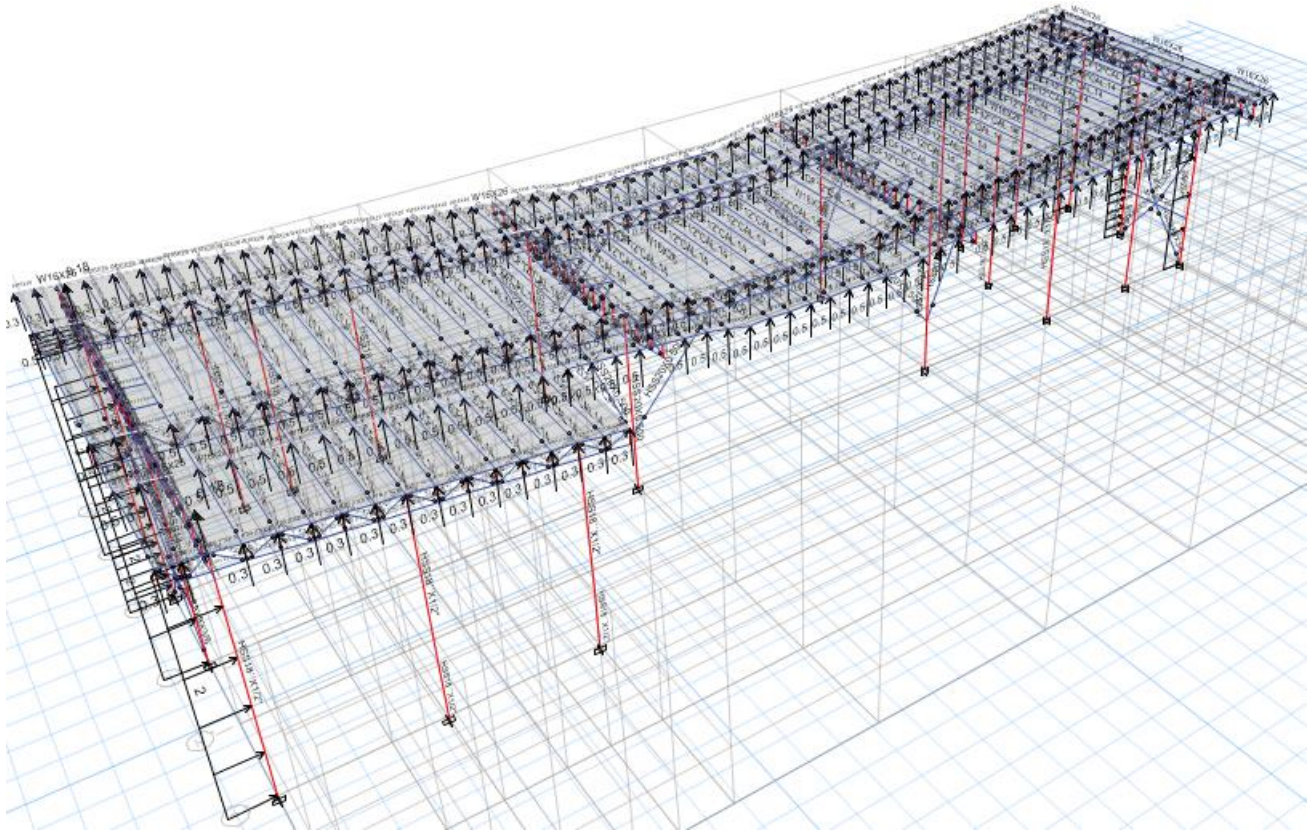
Aplicación de cargas por viento en dirección X (Estructura armaduras).
